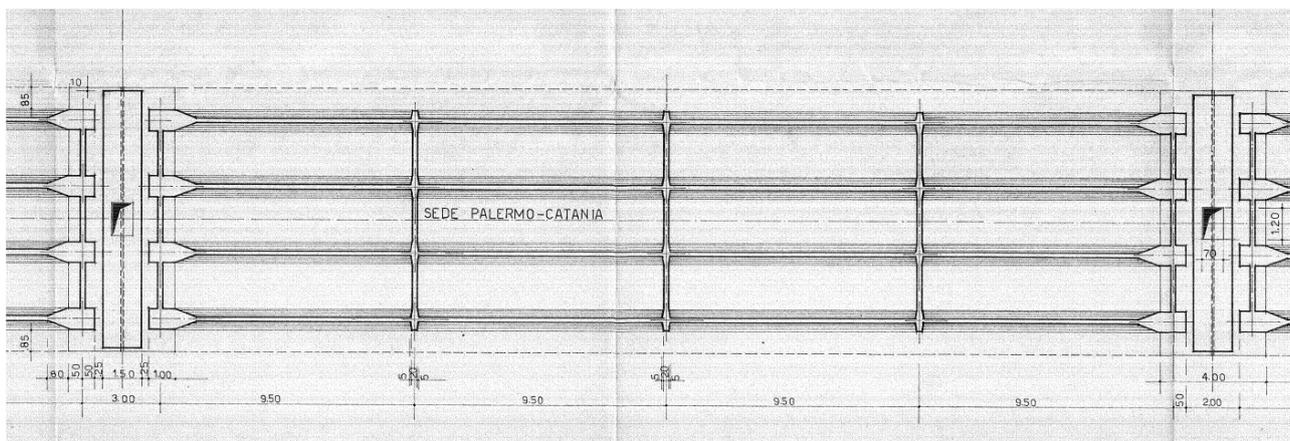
Impalcato a 4 travi in CAP – Pianta
